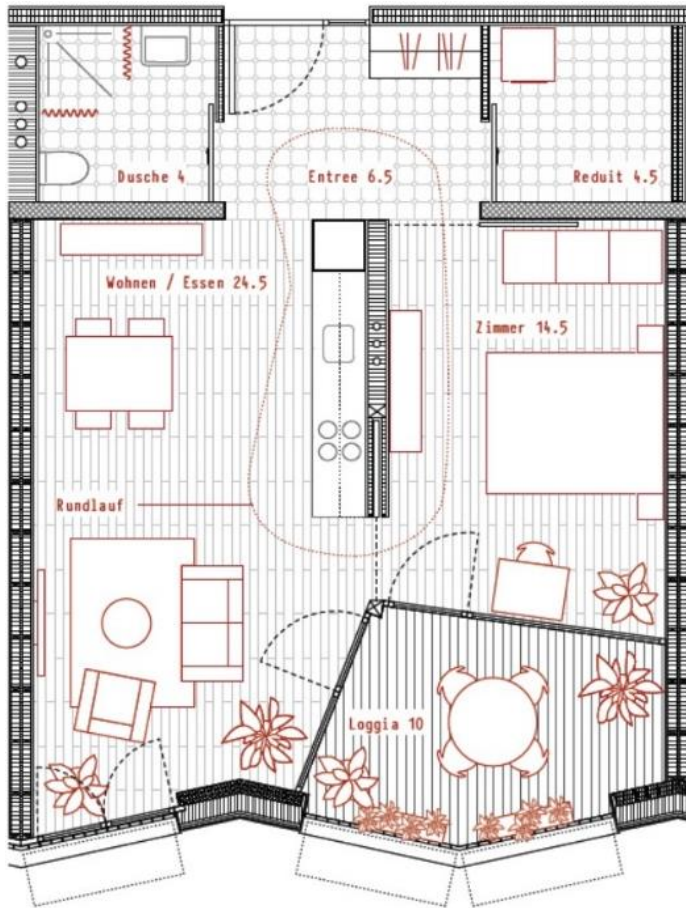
Siegerprojekt "Sorellina", Grundriss 2,5 Zimmer-Wohnung à 49.5 m²
